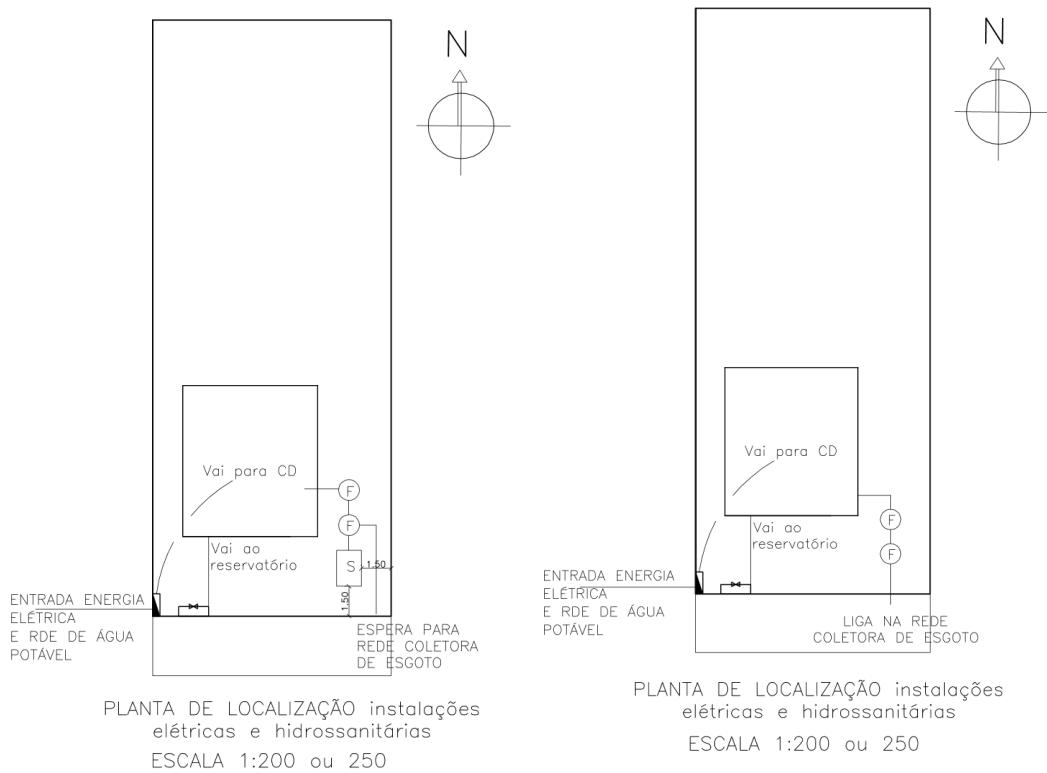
Croquis demonstrativos da planta de localização das Implantações Elétricas e Hidrossanitárias
